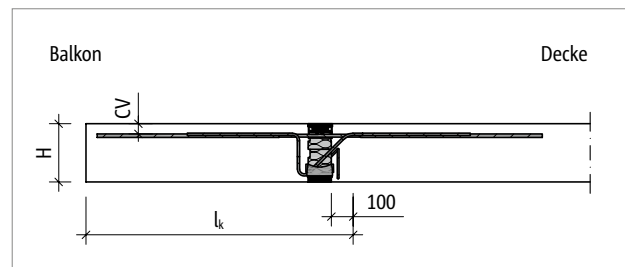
Schöck Isokorb® T Typ KL-M8 bis M12: Statisches System
